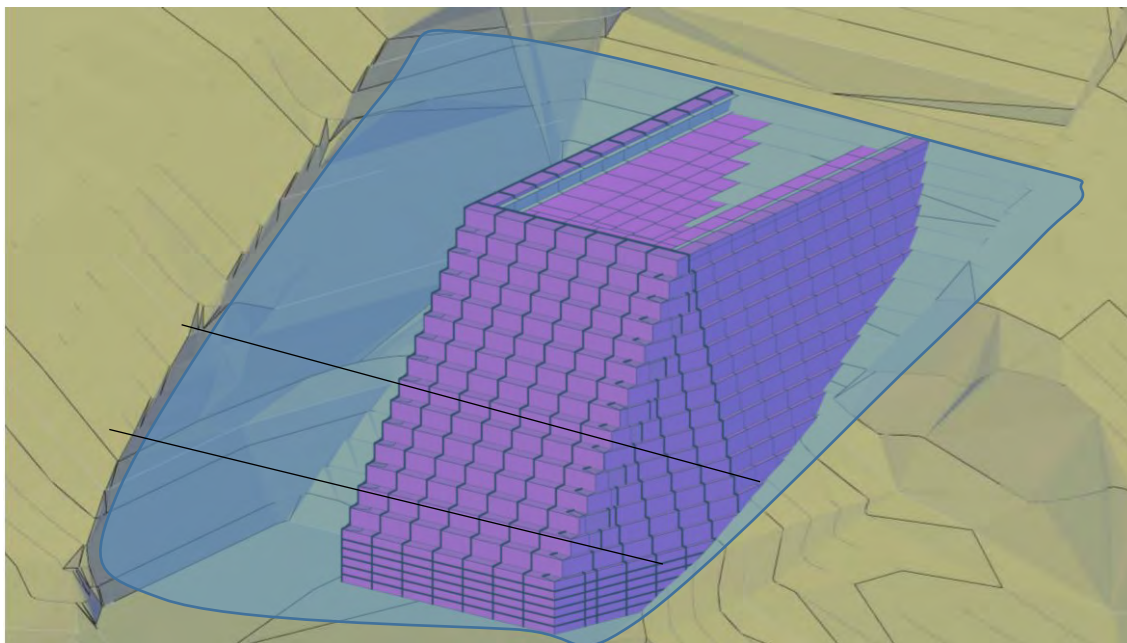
Esquema en planta del emplazamiento de la estructura suelo reforzado.
